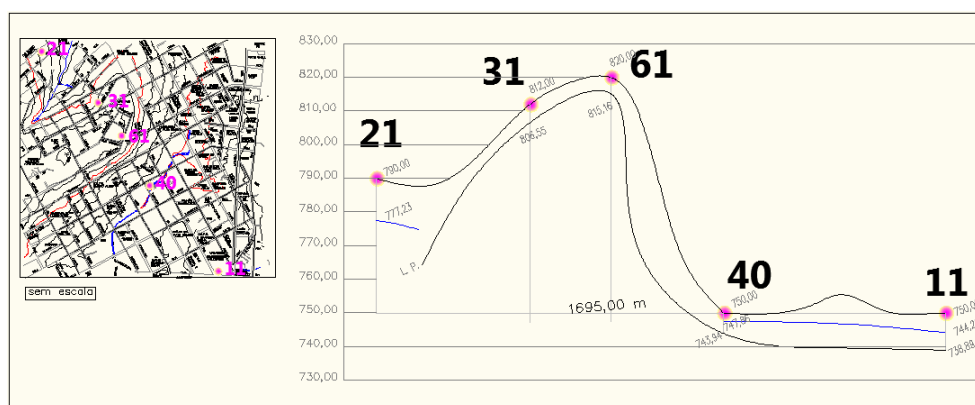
Perfil do subsolo para as sondagens: 21, 31, 61, 10 e 11.
